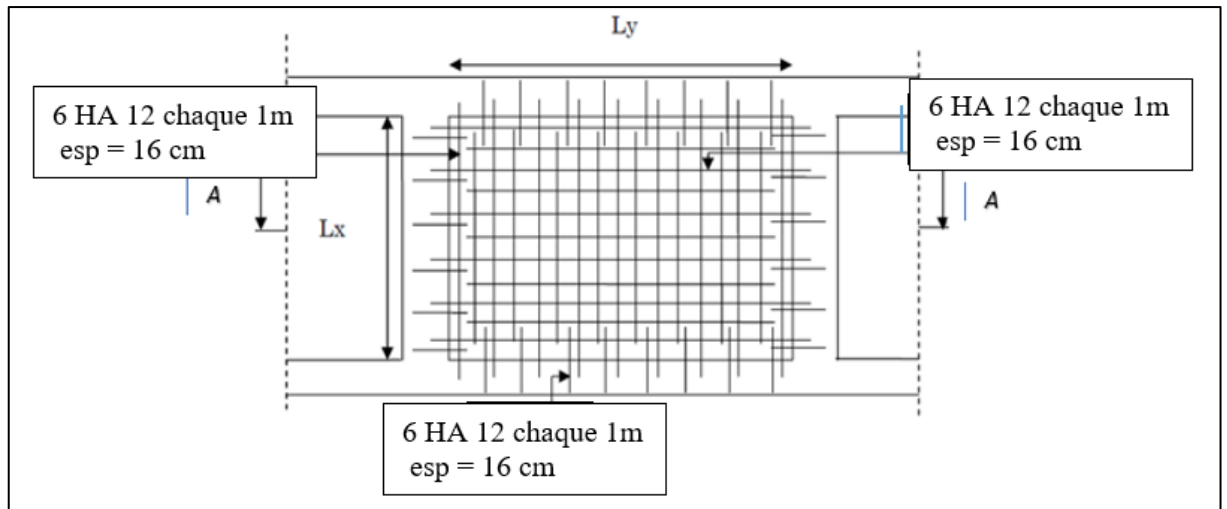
Schéma de ferrailage de la dalle pleine.
